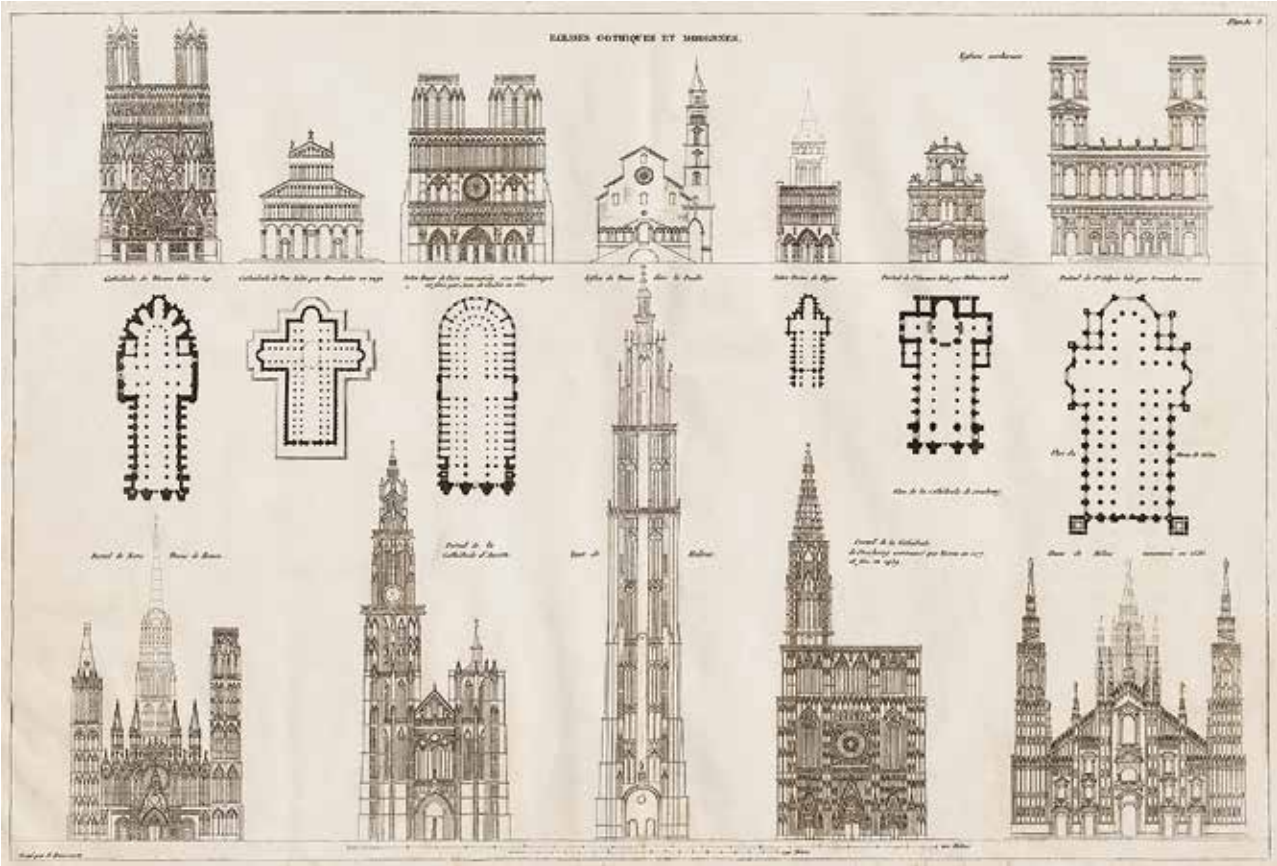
| Berühmte historischen Kirchen, vor allem des Mittelalters. Notre Dame in Dijon mit Fassade und Grundriss an fünfter Stelle von links, aus: Durand/Legrand 1801, tab. 8
